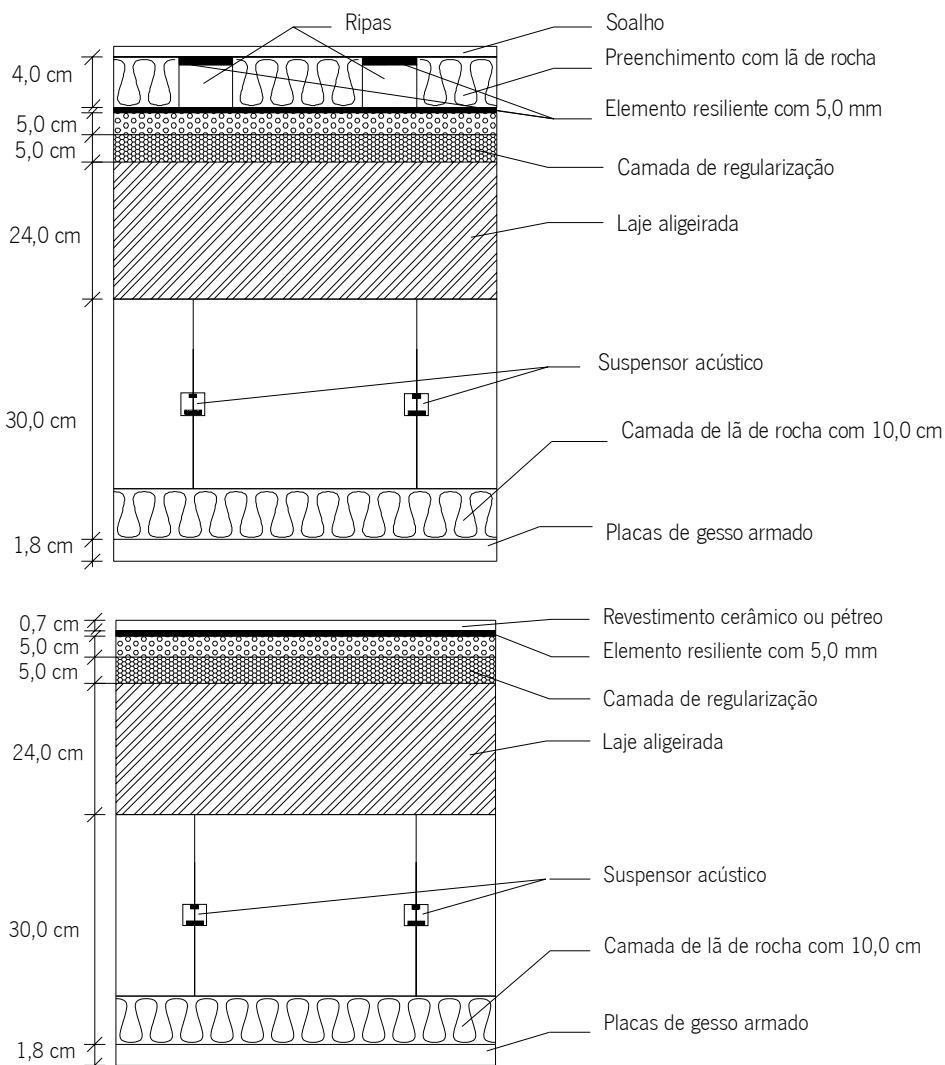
Pavimento de separação entre uma habitação e a zona de escritórios com soalho de madeira e com material cerâmico ou pétreo, Pav2
